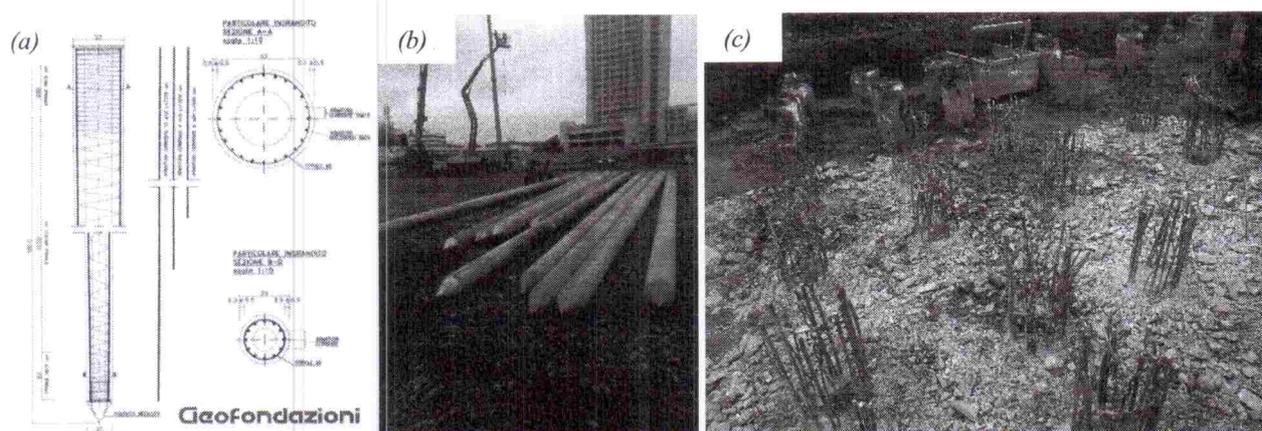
Pilo infisso prefabricato troncoconico: (a) caratteristiche geometriche (sezione verticale e armature), (b) vista dei pali nell'area di cantiere, (c) armature di ancoraggio a seguito della battitura e scapitozzatura dei pali.
